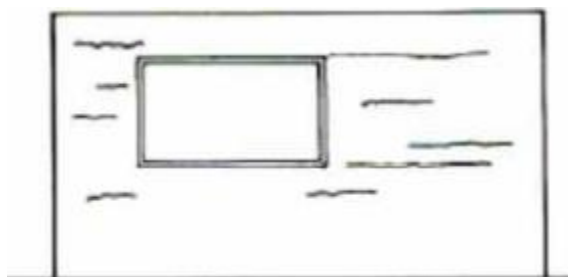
Fissuras horizontais provocadas pela expansão da argamassa de assentamento. Fonte: (Thomaz, 1989).
